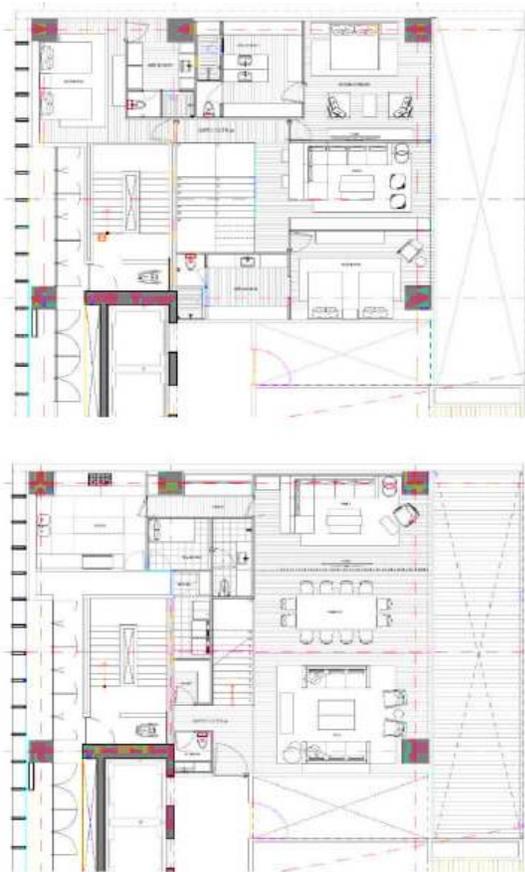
Planta tipo (PB) (PA). Abilia.com
